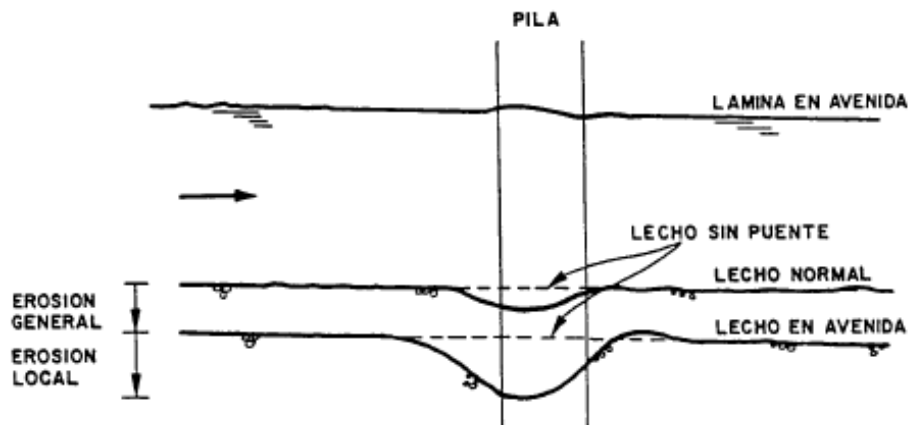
Esquema de tipos de erosión en el pilar de un puente.
